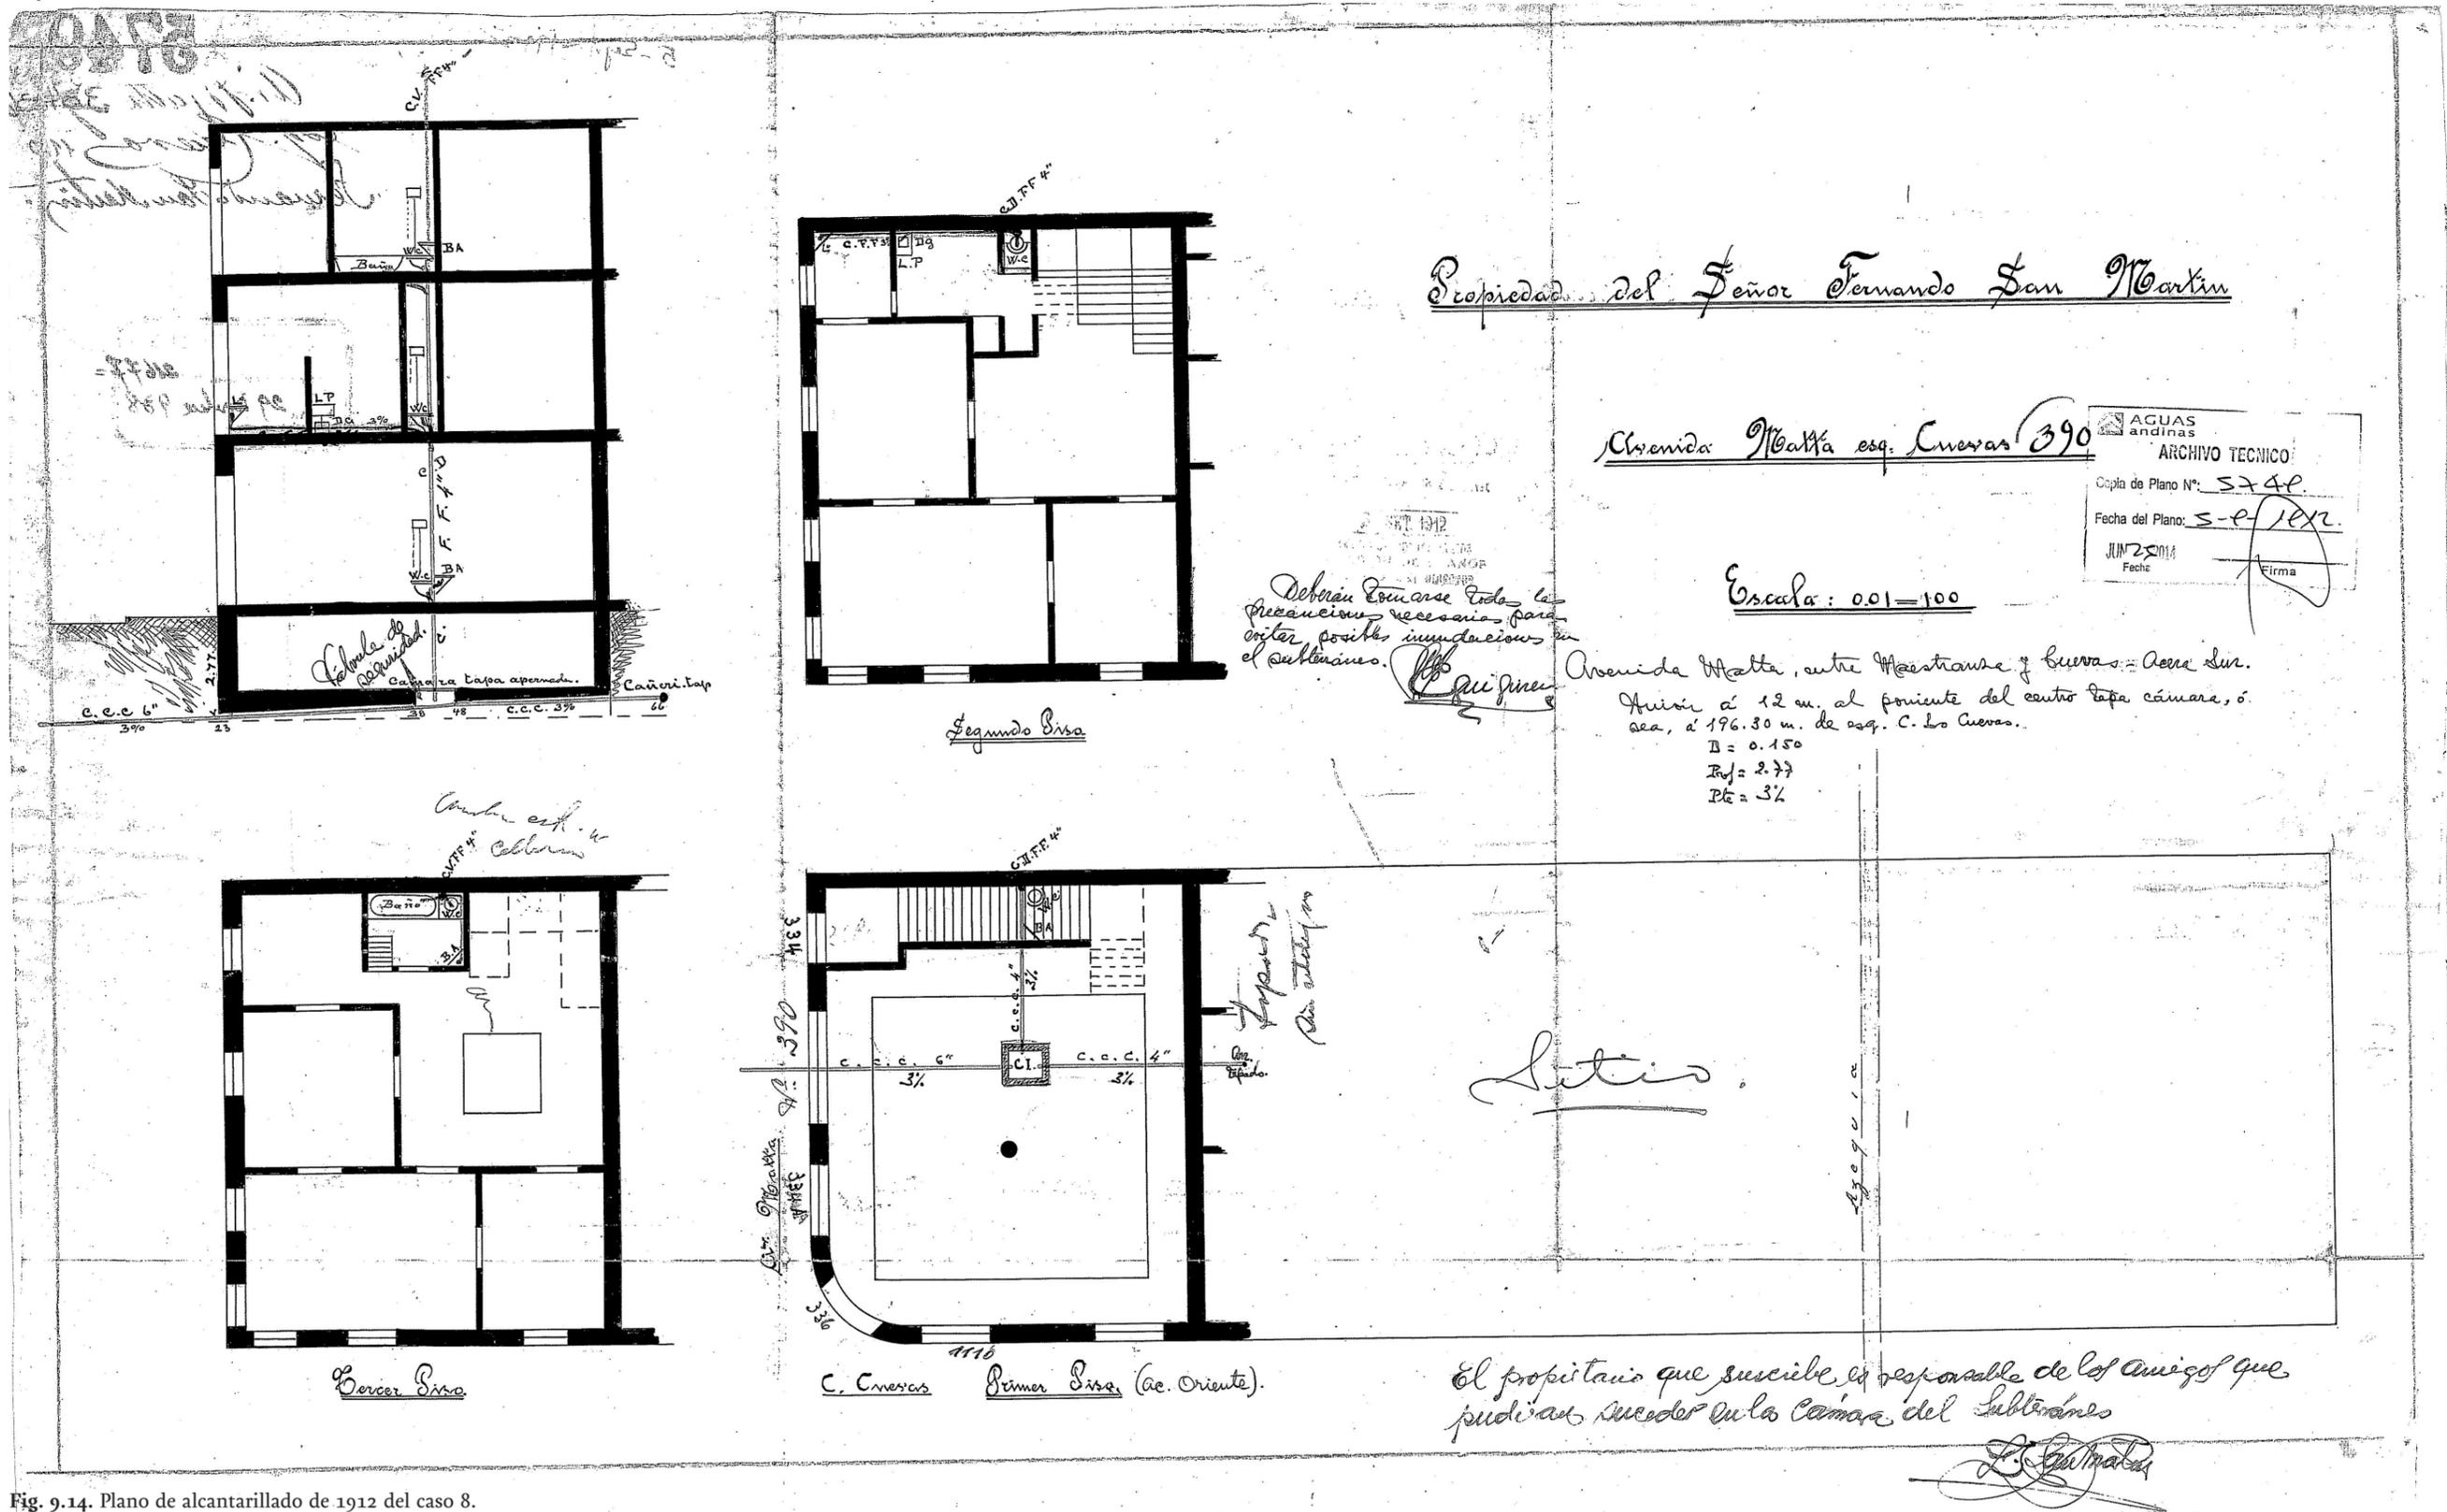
Plano de alcantarillado de 1912 del caso 8.
